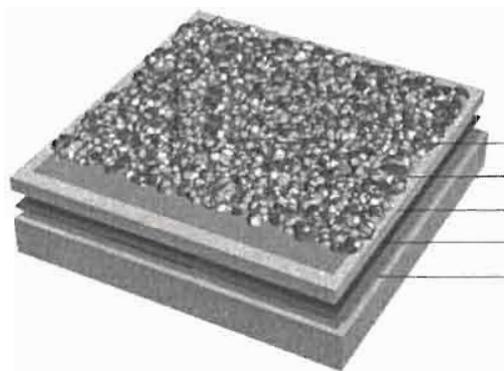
Устройство инверсионной кровли с покрытием из гравия:
